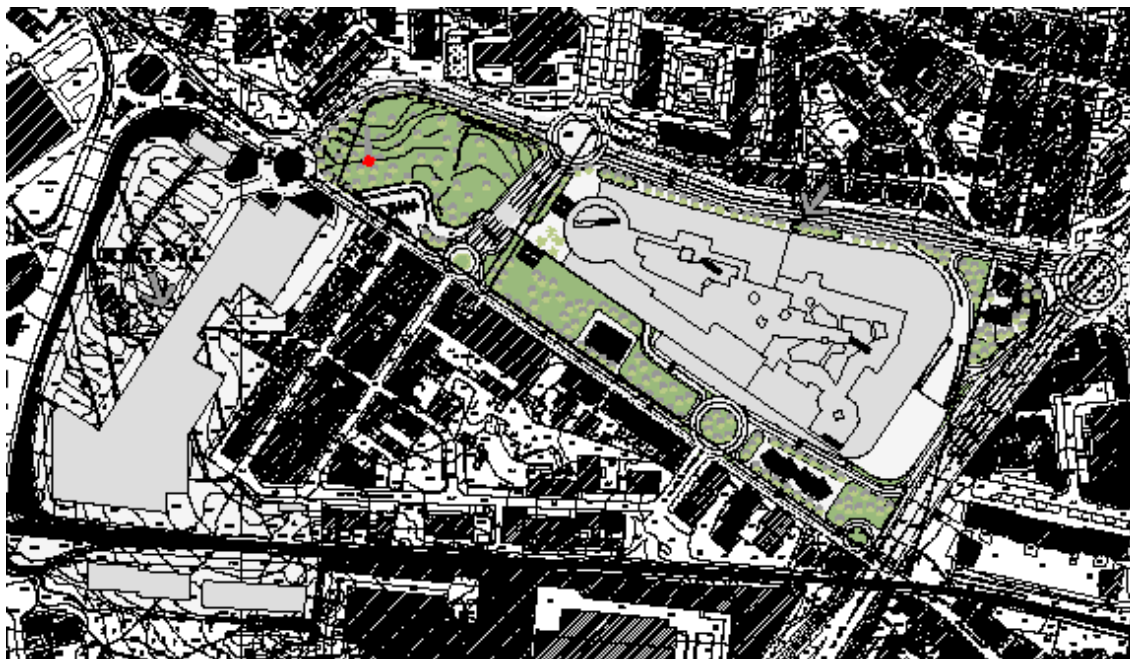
Planta Global de Implantação do Centro Comercial de Portimão
